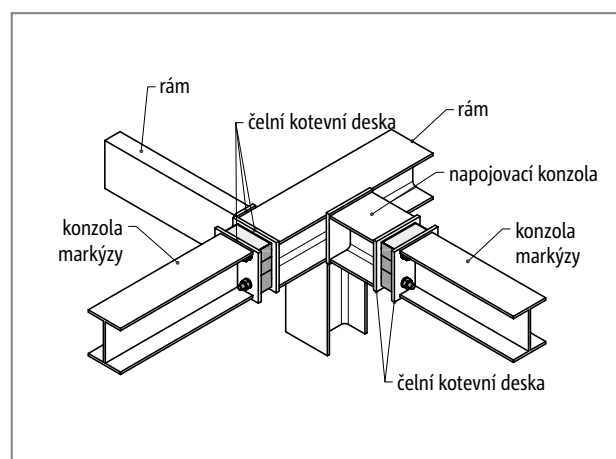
Schöck Isokorb® T typ S-N a T typ S-V: Volně vyložená ocelová konstrukce
